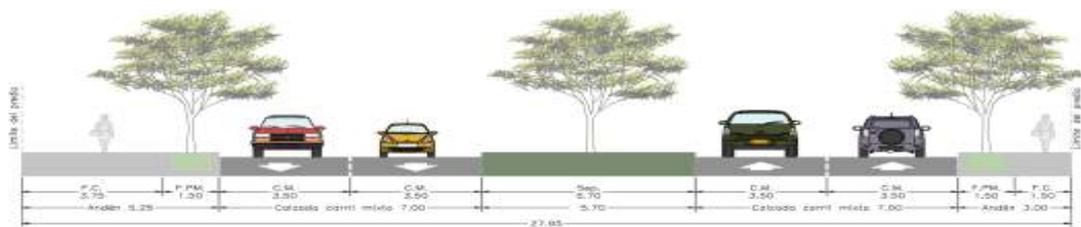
Sección Típica sobre la Calle 8 Sur entre la Autopista Sur y la KR 27 Fuente: Elaboración Propia 2017.
